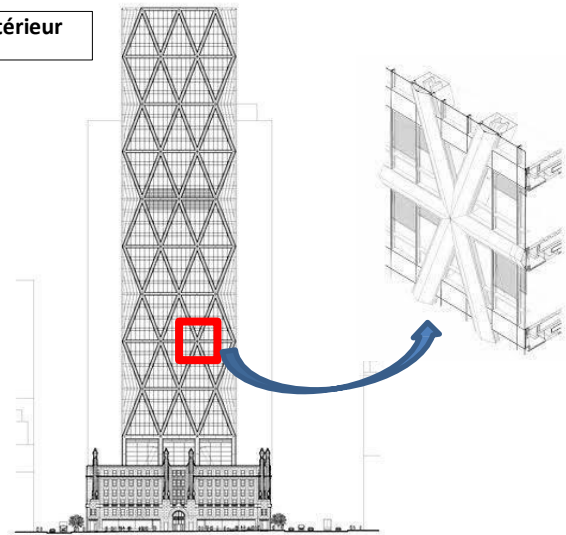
la façade principale de Hearst Tour avec un zoom sur la structure
